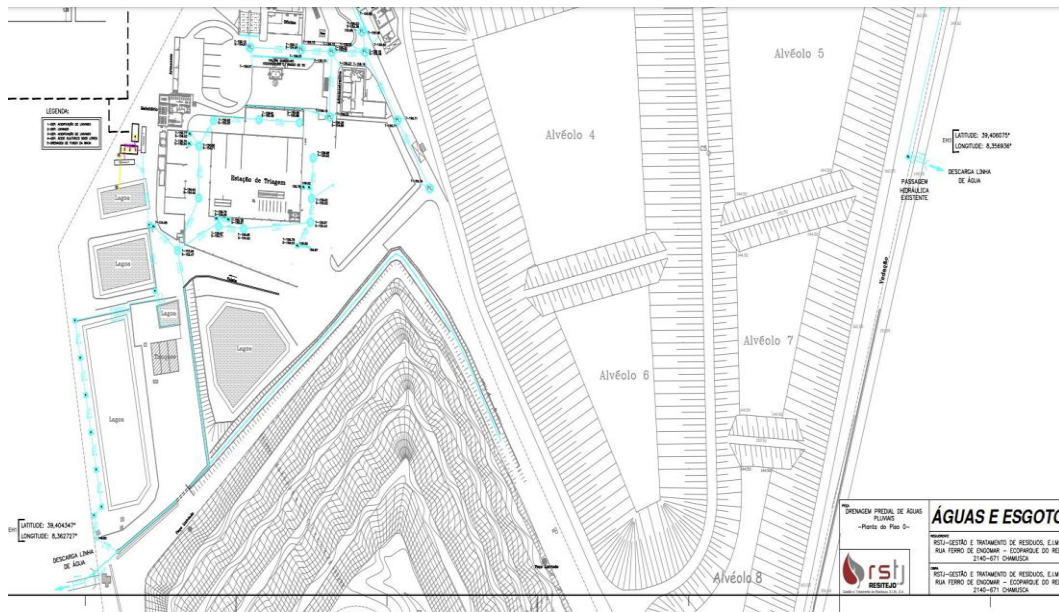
Extrato da peça desenhada nº PL1 “Drenagem predial de águas pluviais – Planta do Piso 0”, março 2023
